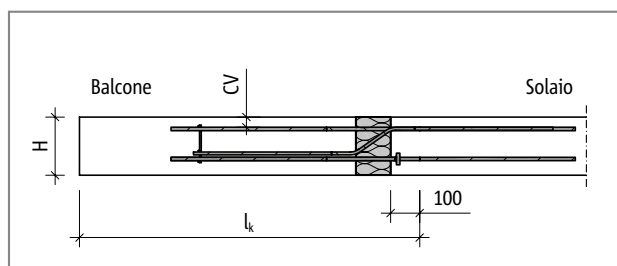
Schöck Isokorb® tipo EXT: schema statico
